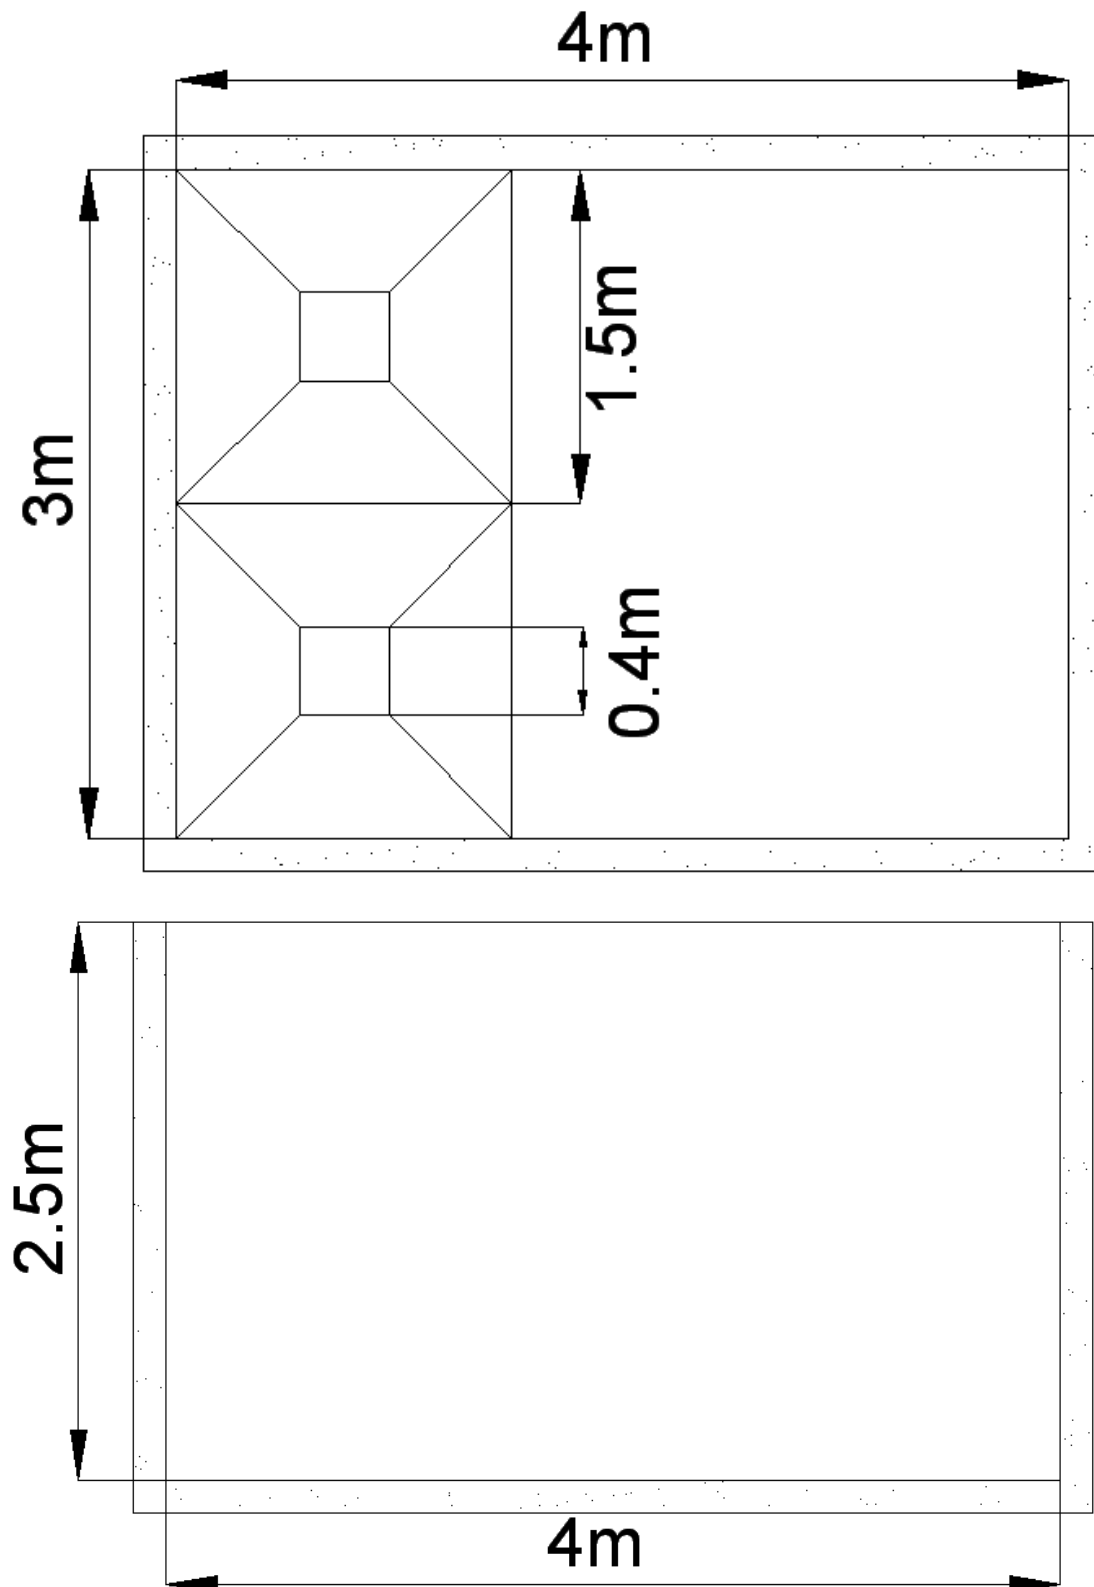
vista en planta y de perfil del sedimentador secundario
